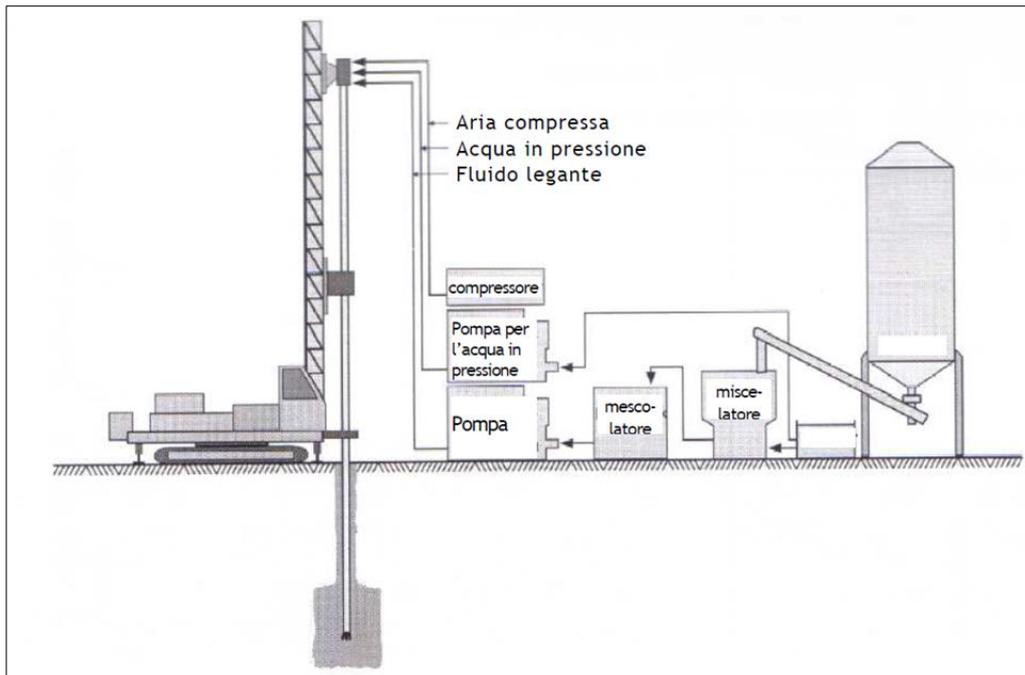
sezione schematica - tipologico installazioni di cantiere per jet grouting
